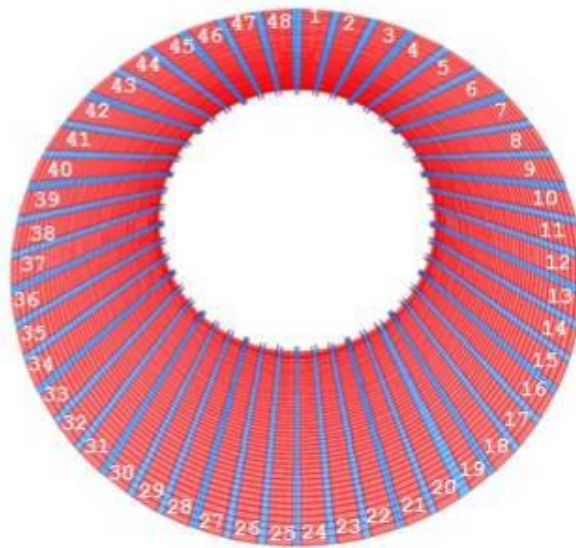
Distribución de armados en modelo tridimensional (ver plano CIM-ING-UNT-PLA02).
